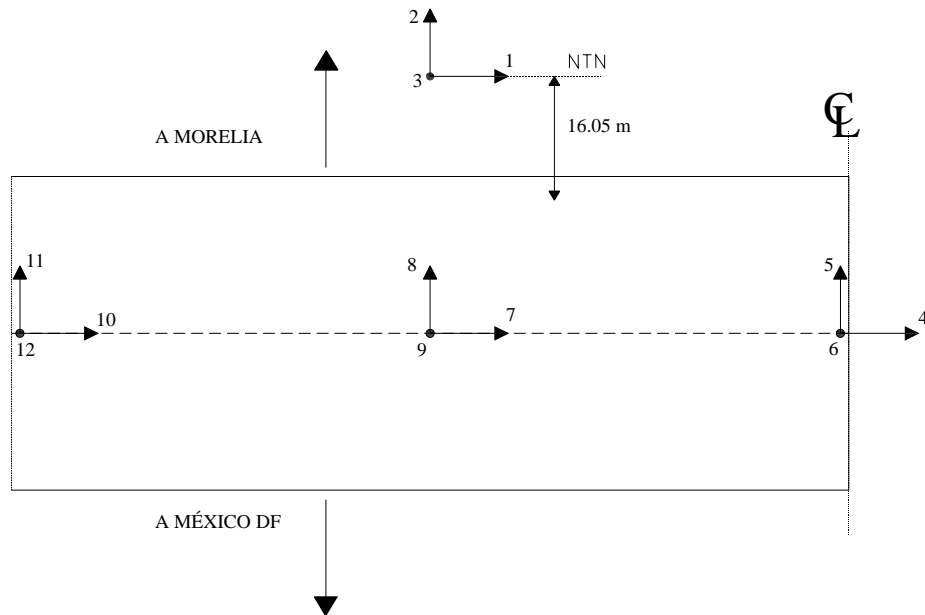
Distribución de los sensores para la primera alternativa en el puente Maravatío kilómetro 187+310
